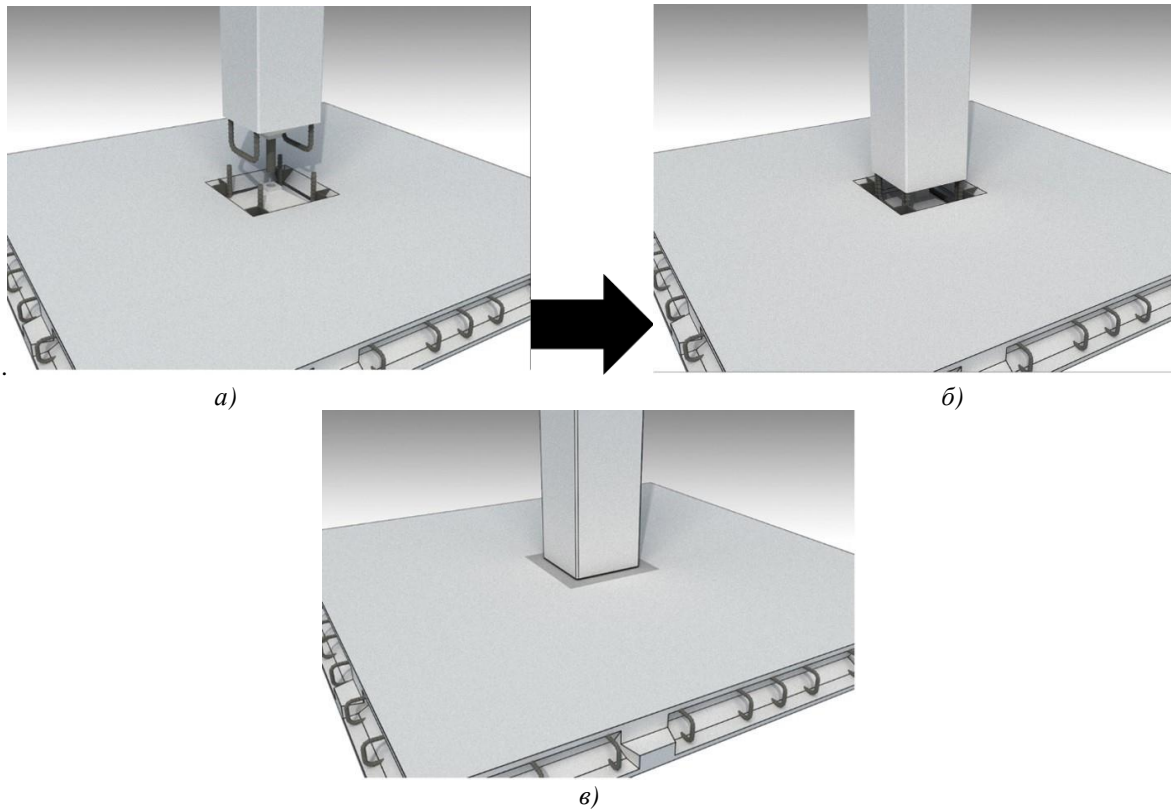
Узел сопряжения железобетонных колонн и плиты перекрытия:
